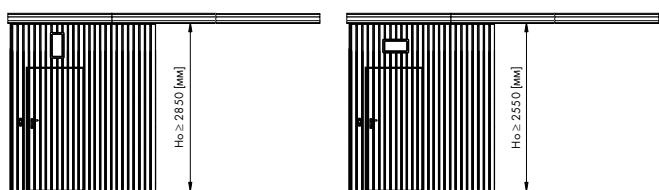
Остекление расположенное вертикально и горизонтально над проходными дверями в подвесных однопольных воротах – вид с наружной стороны.
